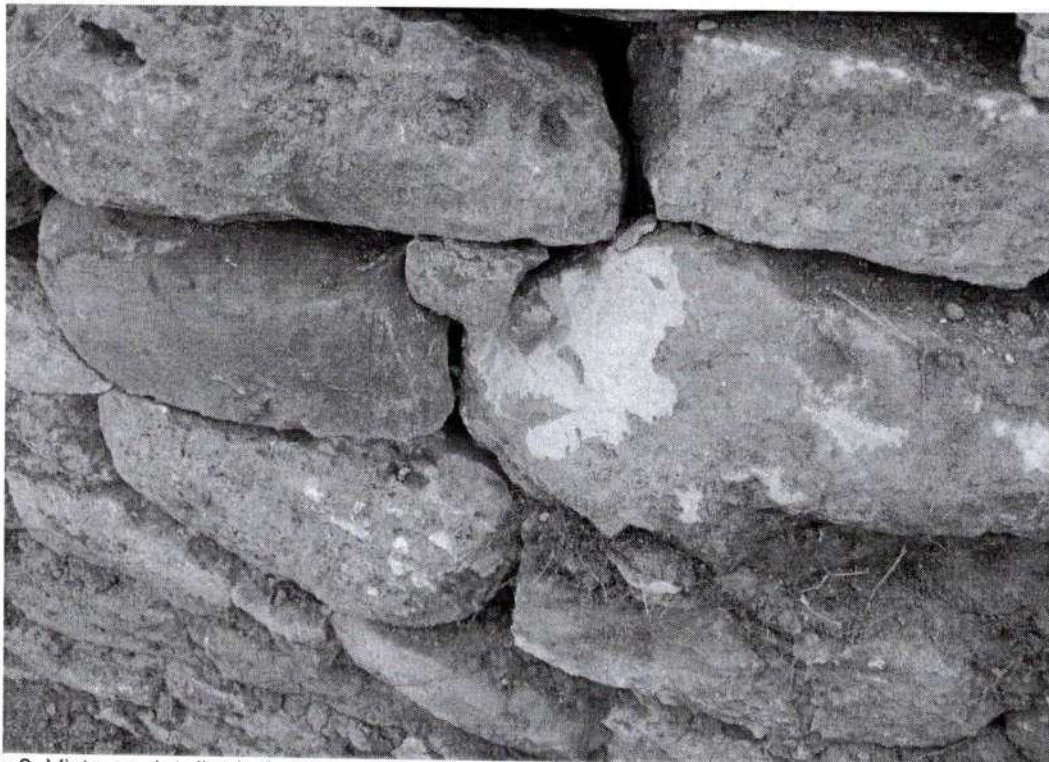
Vista en detalle de fractura de un piedra que es parte de un muro (inspección: 13/11/2025.)
